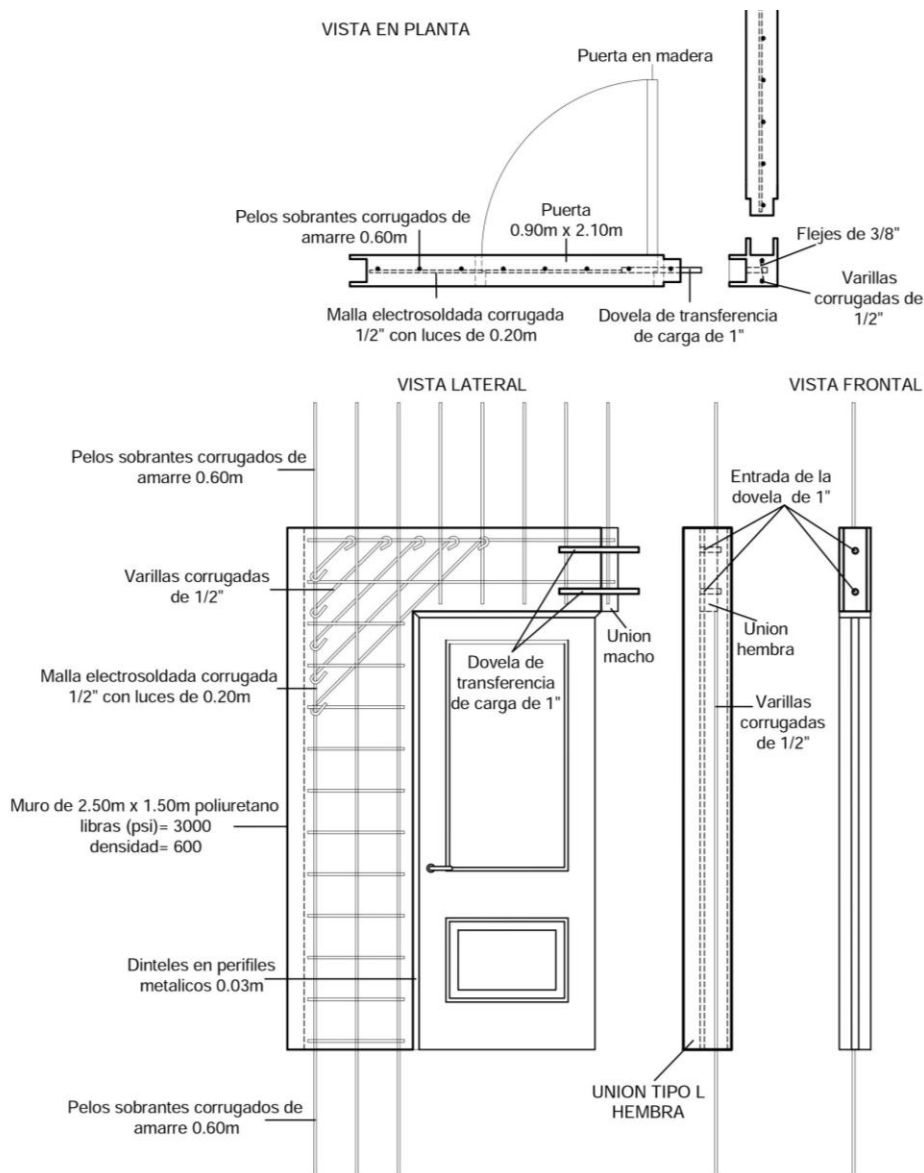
Muro con puerta tipo 1 y malla electrosoldada de $\frac{1}{2}$ "
